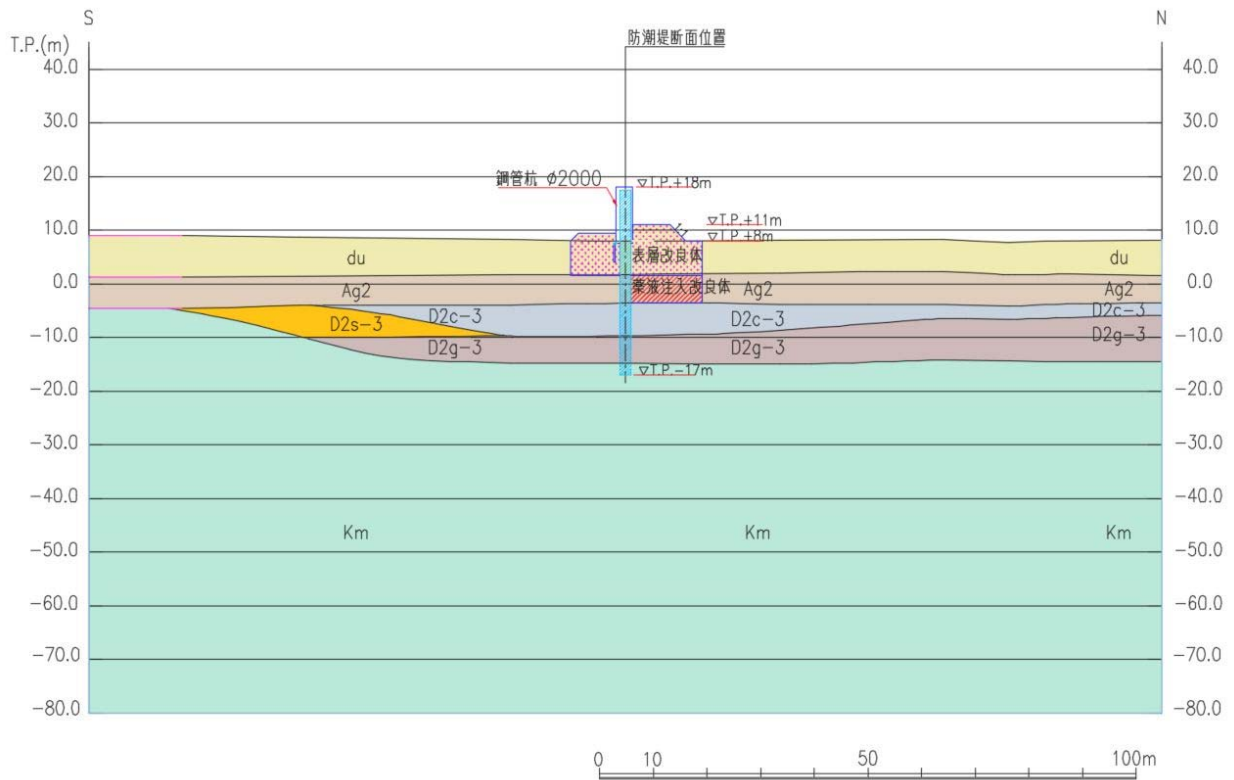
(1) 鋼管杭鉄筋コンクリート防潮壁 断面図 (断面①)
